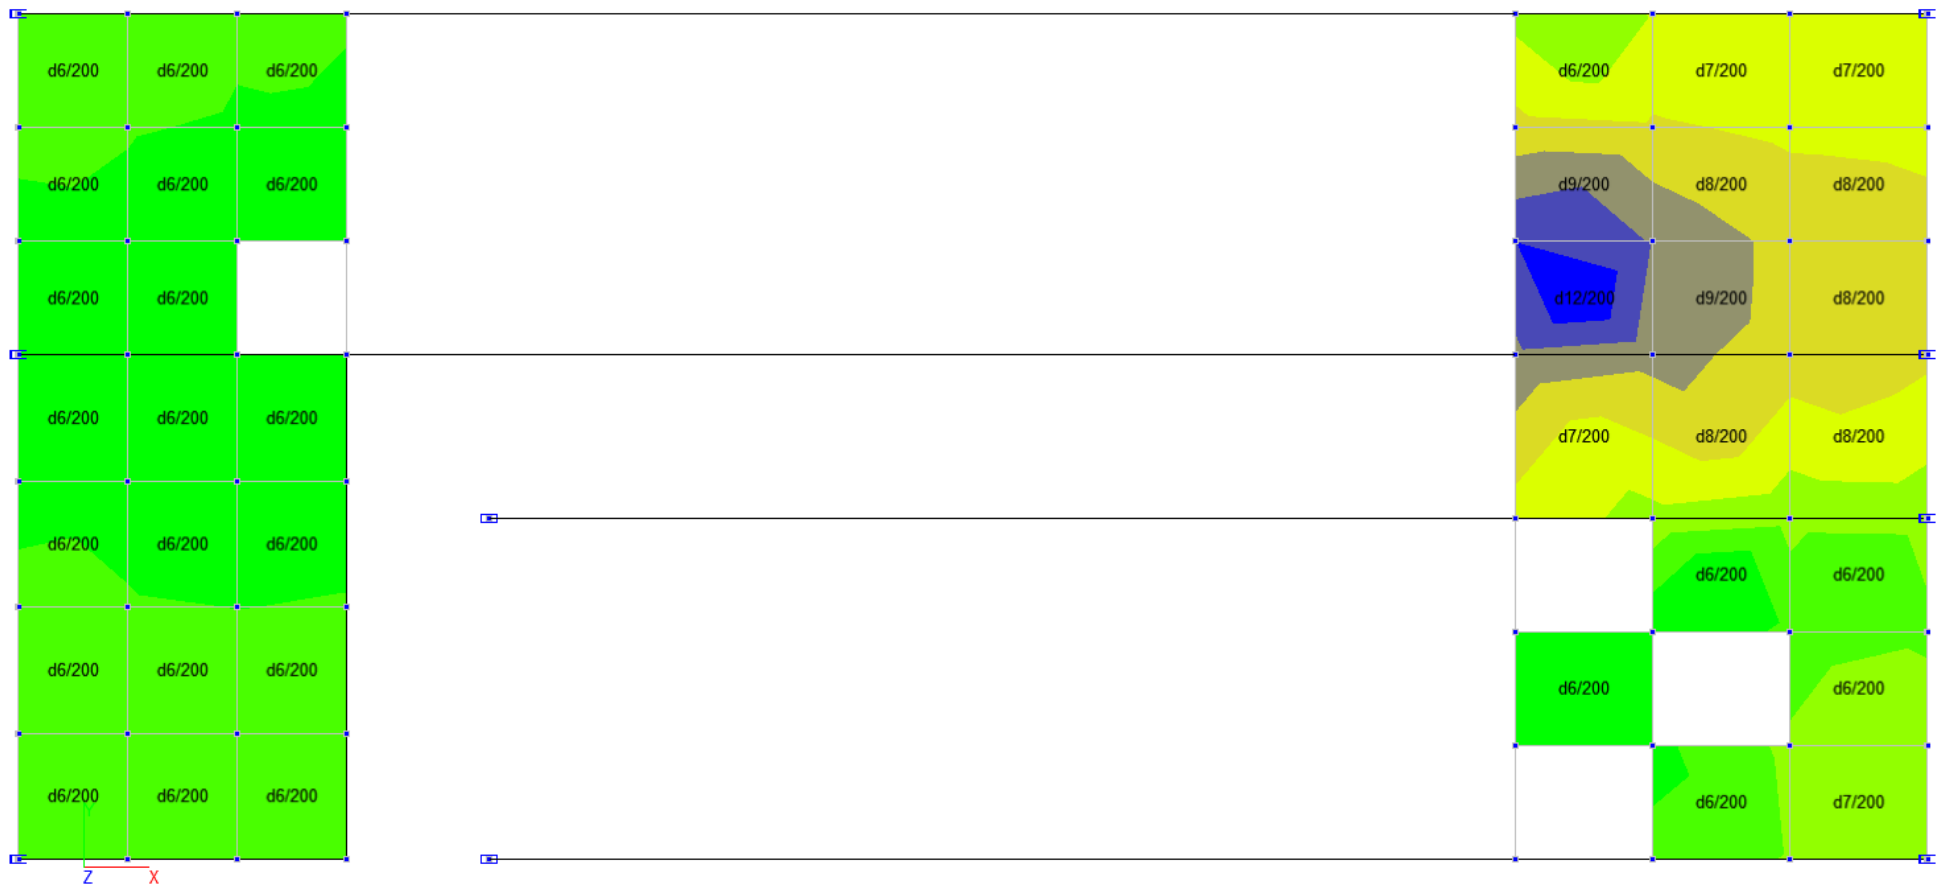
Нижнее армирование по Y (см²/м)
